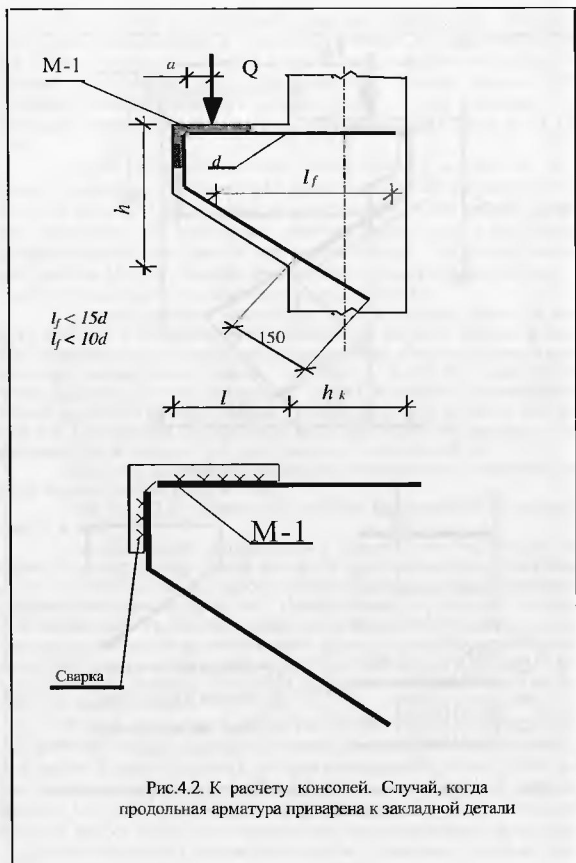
К расчету консолей. Случай, когда продольная арматура приварена к закладной детали
